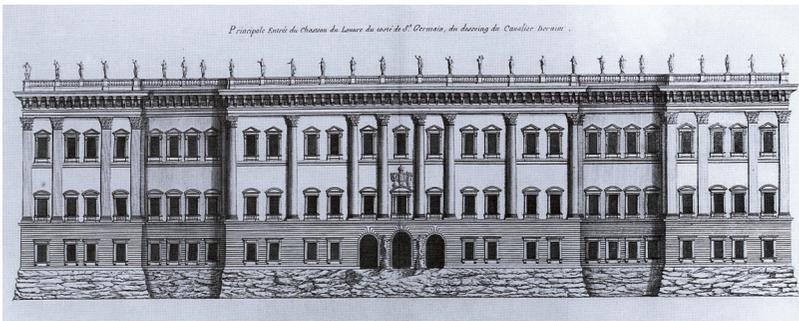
Desenho em elevação do acervo do Metropolitan Museum of Art, de Nova Iorque, mostrando o terceiro projeto para a fachada leste do Palácio do Louvre. (MARDER, 1998, p. 268)
